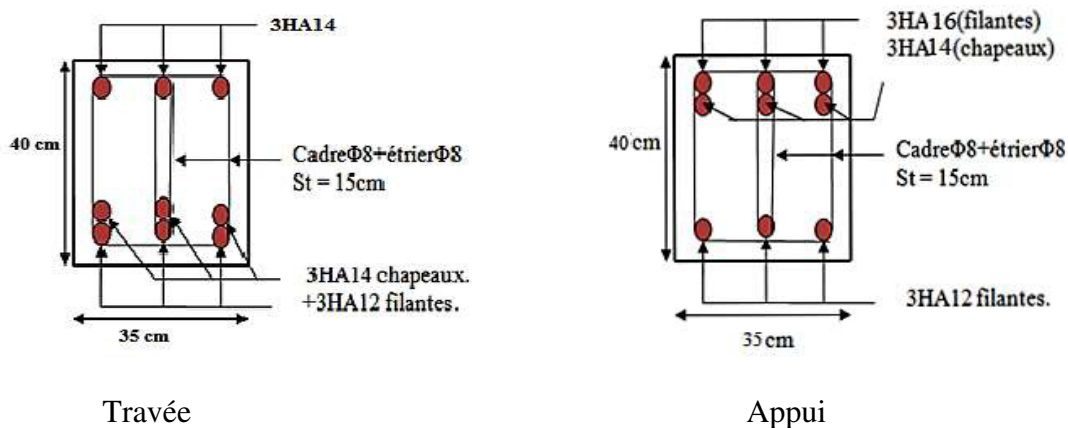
Schéma de ferrailage des poutres principales des Etages 8 – 9.
